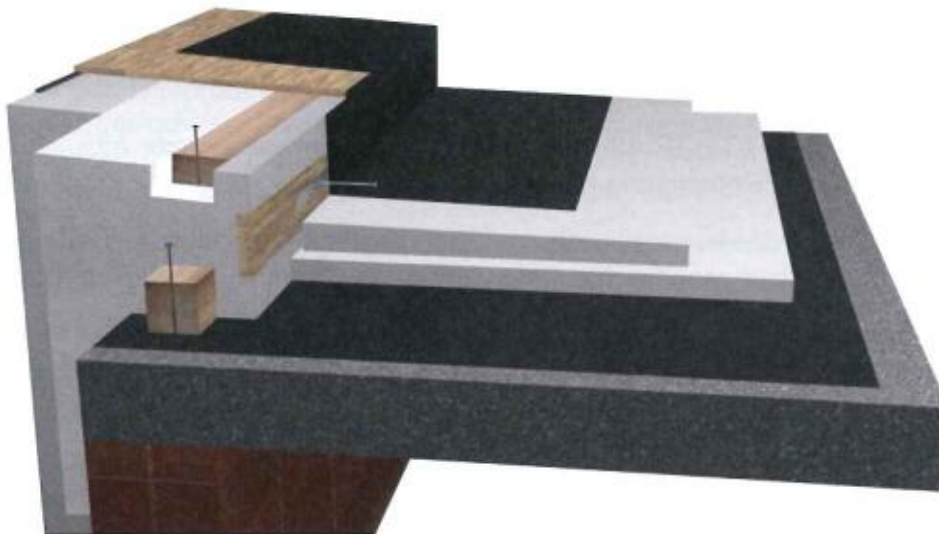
Systematische Darstellung Attika-Element Fassade integriert auf Beton
